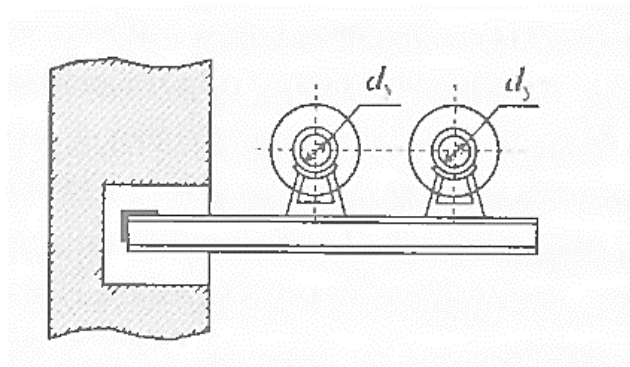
Надземне прокладання теплових мереж по стінам будівель на кронштейнах
